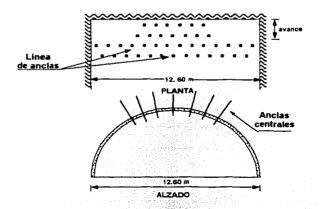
anclaie central, elementos de 1" Ø x 4.2 m
